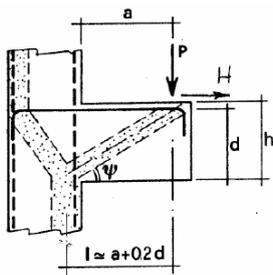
Diffusione delle azioni dal palo al muro frontale
